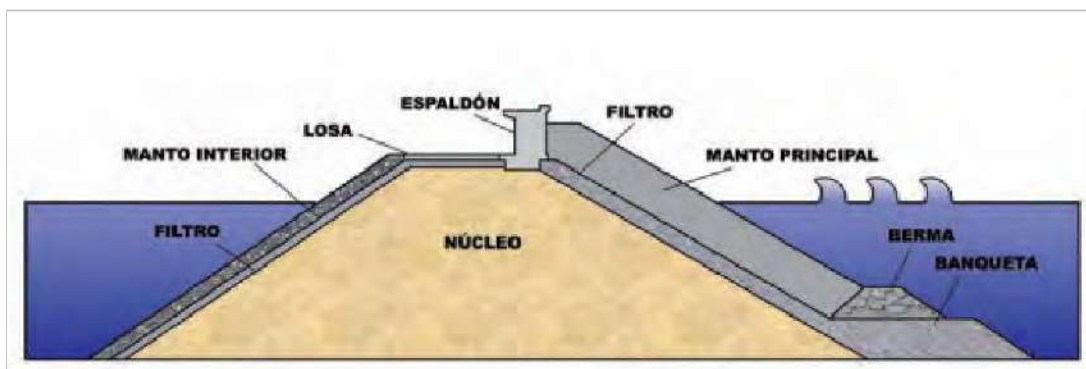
Perfil constructivo de dique en talud. Fuente y elaboración: Ministerio de fomento de España, 2006.
